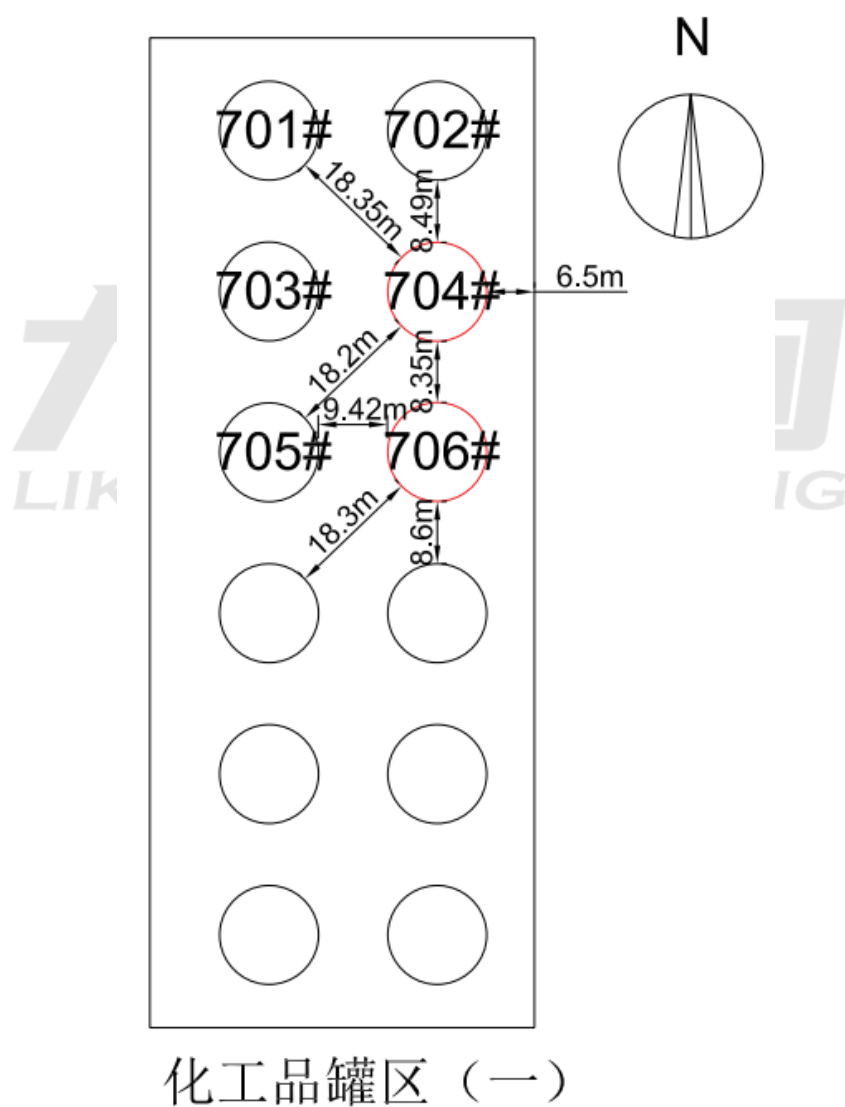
营口华油实业公司租赁储罐所在罐区平面布置图
